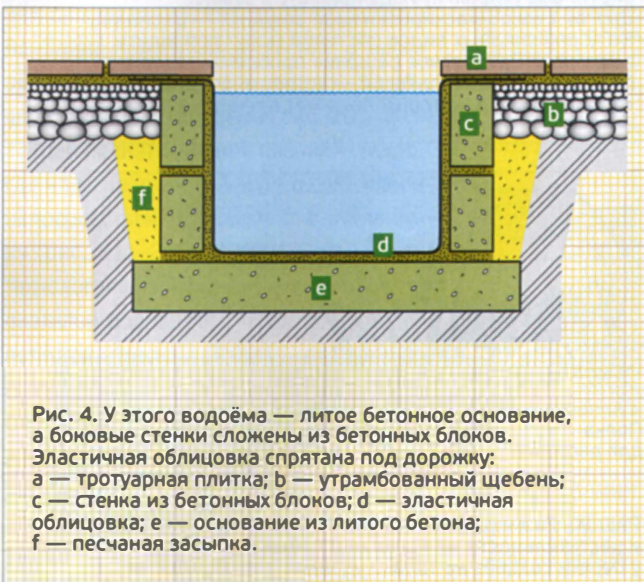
У этого водоёма — литое бетонное основание, а боковые стенки сложены из бетонных блоков. Эластичная облицовка спрятана под дорожку: а — тротуарная плитка; б — утрамбованный щебень; с — стенка из бетонных блоков; д — эластичная облицовка; е — основание из литого бетона; ф — песчаная засыпка.
